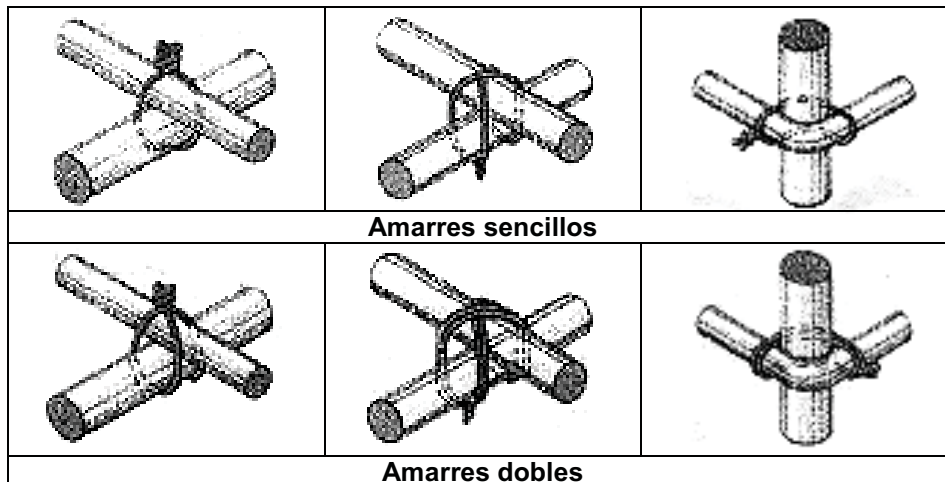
OPCIONES DE AMARRES DE ACERO SENCILLOS Y DOBLES (Reforzados) - Fuente: Grundwissen Bau, BATRAN, BLÄSI, FREY, HÜHN, KÖLHER, KRAUS, ROTHACHER, SONNTAG – Edit. Handwerk und Technik, 2001 – p. 152
